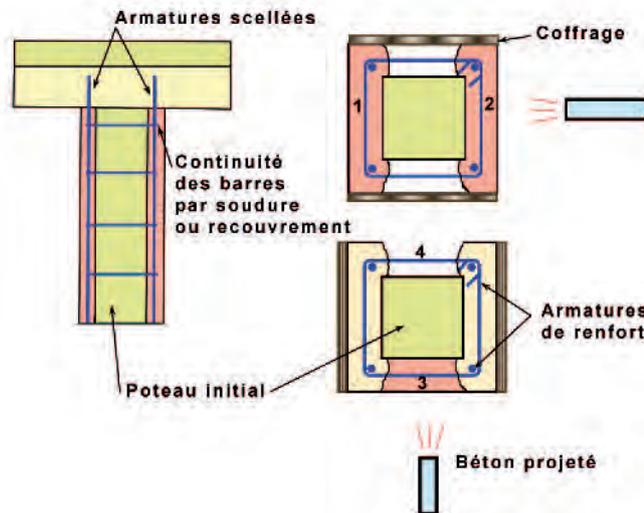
exemple de renforcement d'un poteau par ajout de béton et d'armatures
